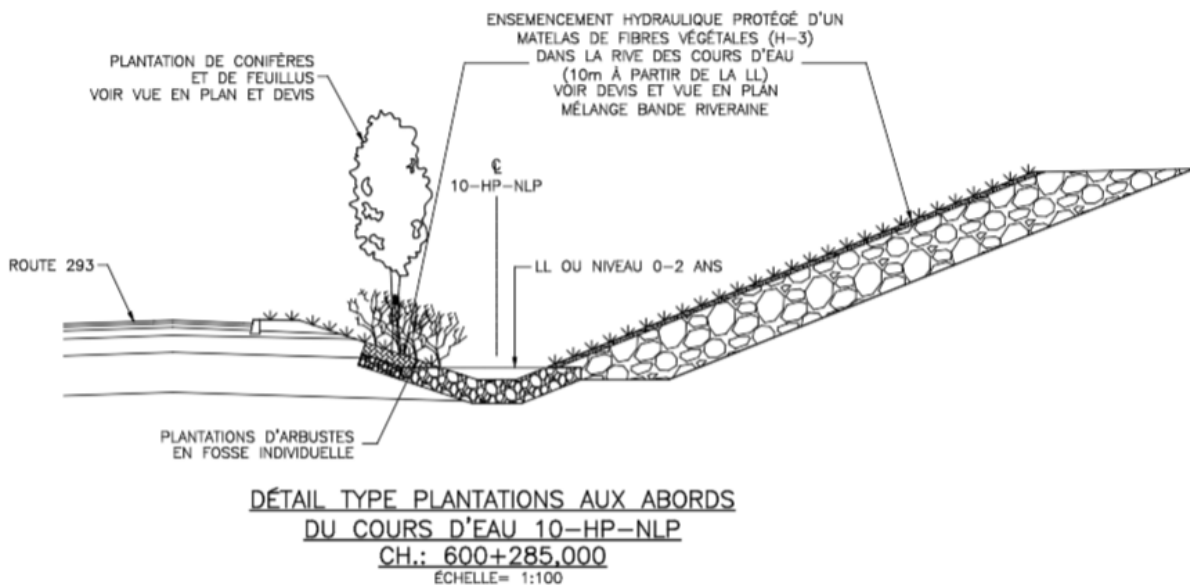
Extrait des plans TP : plantations aux abords du cours d'eau 10-NHP-NLP
